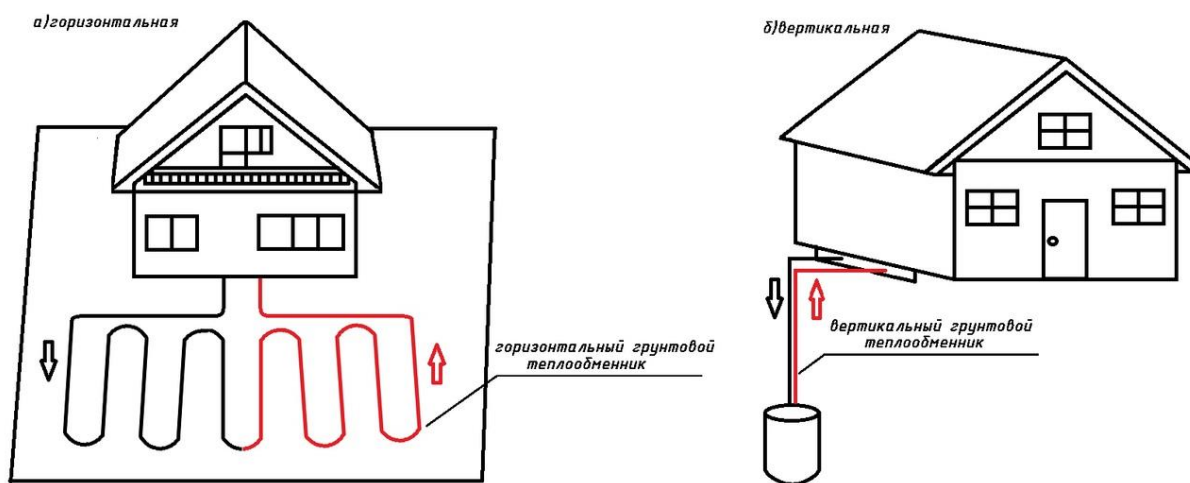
Схема закрытой системы использования низкопотенциальной тепловой энергии грунтовых вод: а – горизонтальная; б – вертикальная
